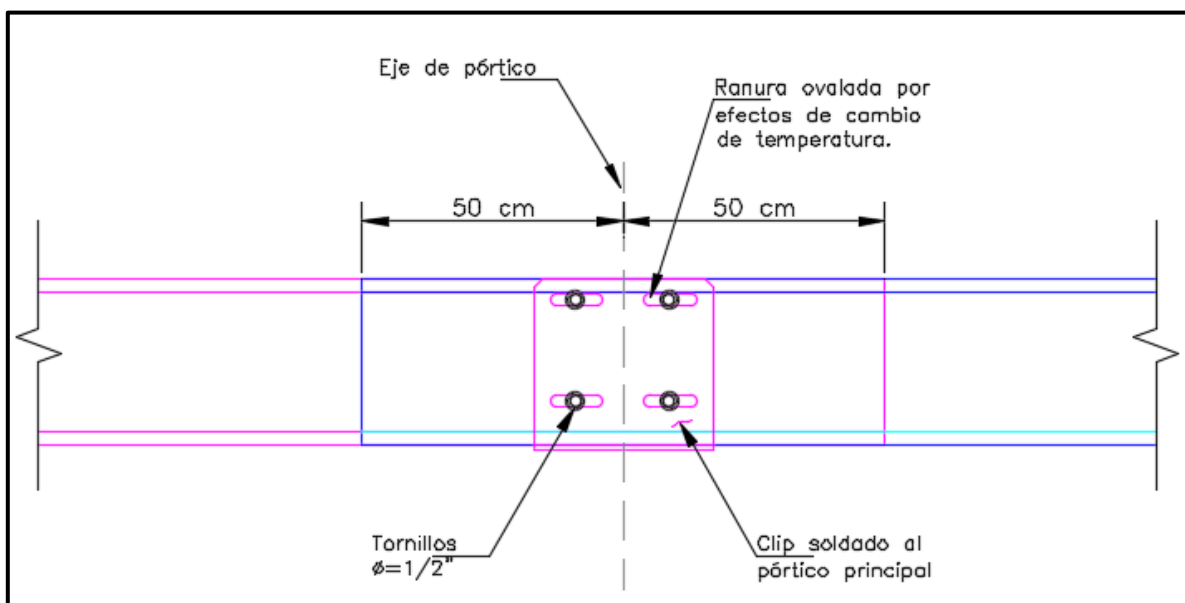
Traslape de perfiles ZF, vista lateral (autoría propia, 2021).
